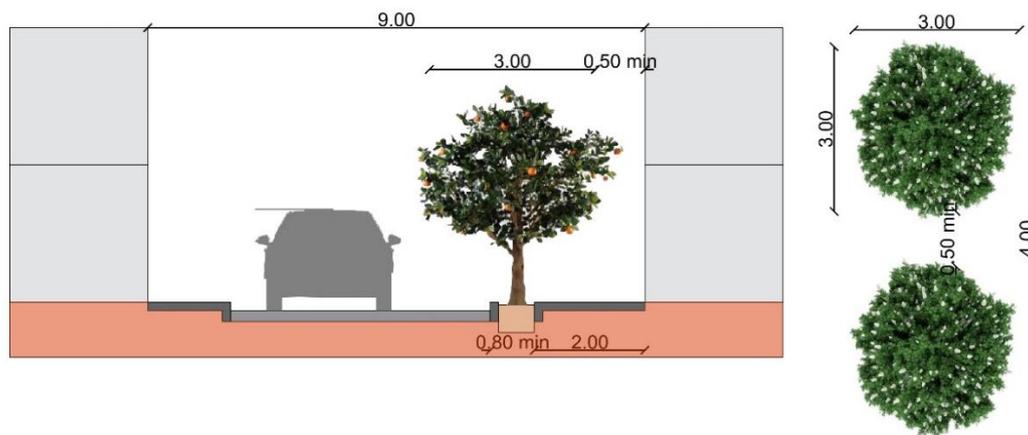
Diagrama para calles estrechas (Autor: Javier Horna)
